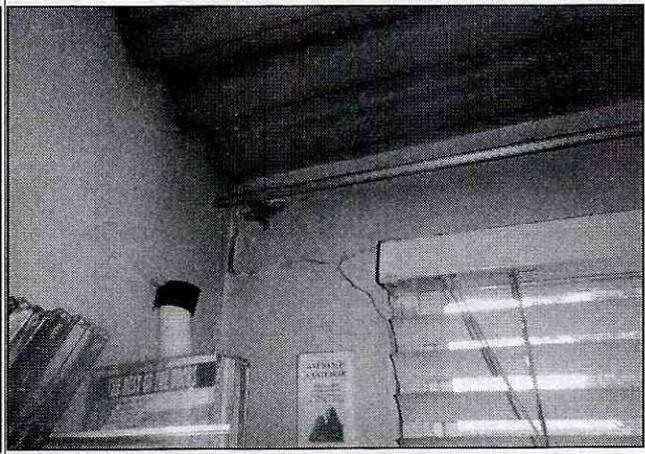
Vista de la fisura que se identificaron al interior de la vivienda.
